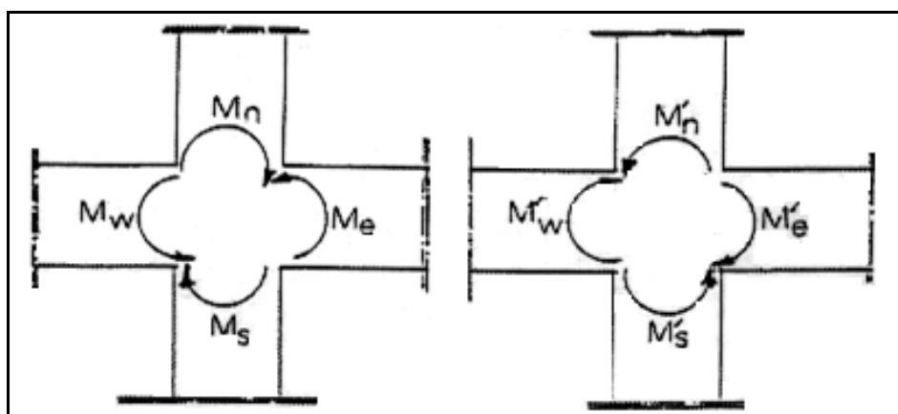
Dimensionnement d'un nœud poutre-poteau [7].
